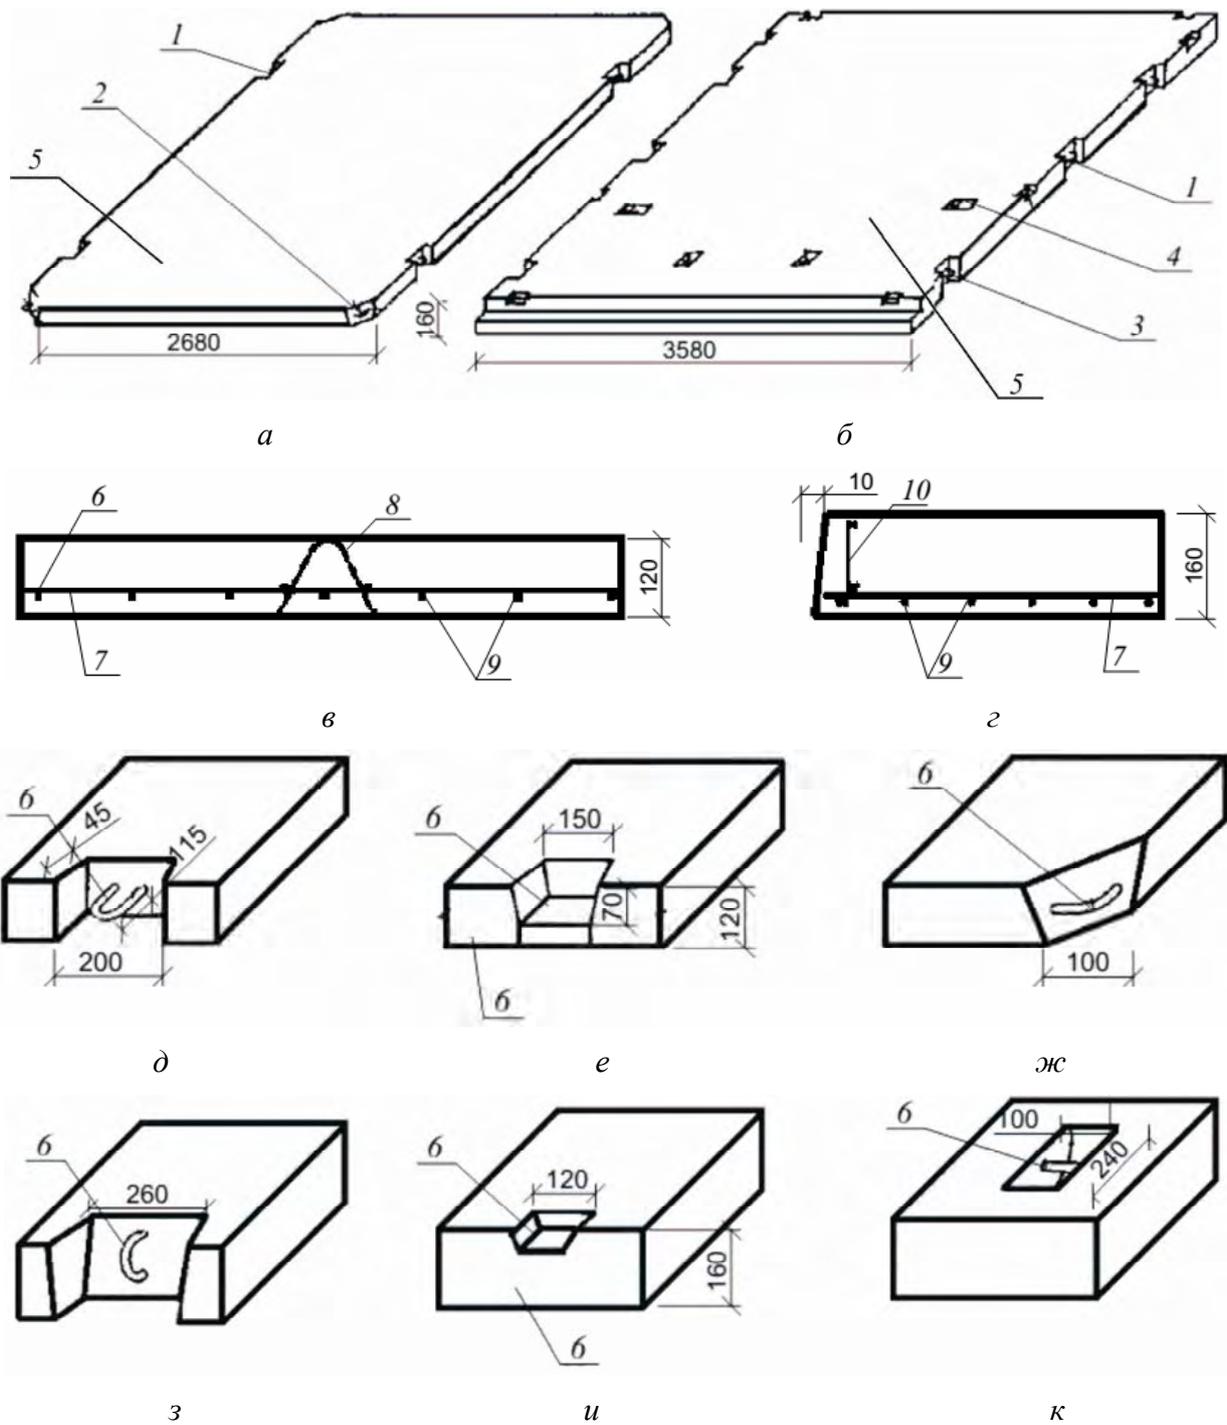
Сплошные железобетонные панели перекрытий крупнопанельных зданий: а, з — подъемные петли; е, и — закладные детали для сварных креплений панелей; ж — арматурный выпуск на углу панели; к — петля крепления монтажных подкосов: 1 — закладная деталь; 2 — арматурный выпуск; 3 — подъемная петля; 4 — петля для подкоса; 5 — сплошная панель перекрытия; 6 — стержень выпуска; 7 — сетка; 8 — пространственный каркас; 9 — рабочие стержни; 10 — плоский каркас
